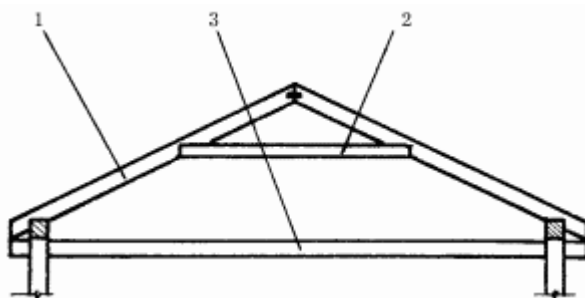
Наслонные стропила: 1 – стропильная нога; 2 – ригель; 3 – чердачное перекрытие.
